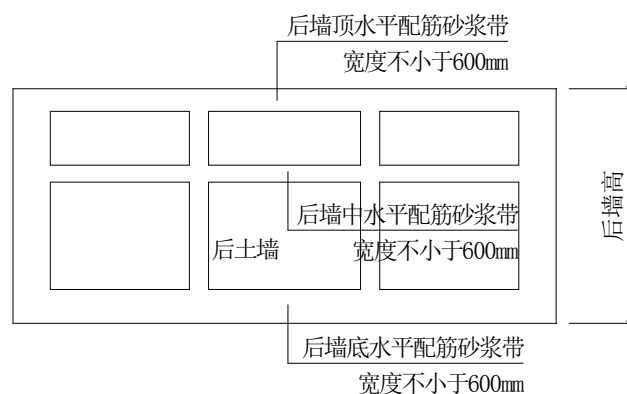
三间房后墙水平配筋砂浆带的布置示意图
